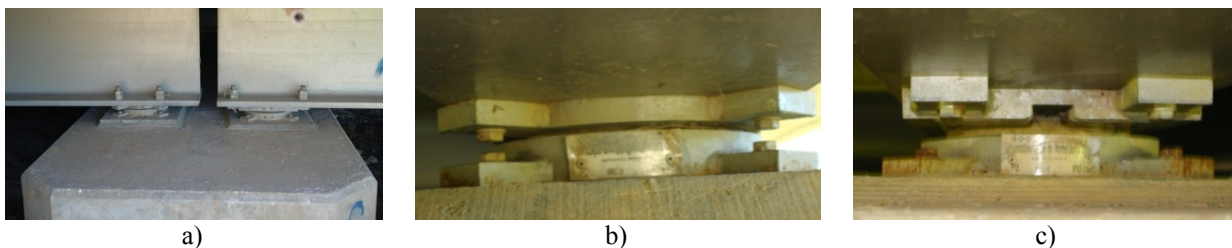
Aparelhos de apoio da ponte de Antuã no pilar P3: a) aparelho de apoio fixo (esquerda) e guiado longitudinalmente (direita); b) aparelho de apoio fixo; c) aparelho de apoio guiado.
